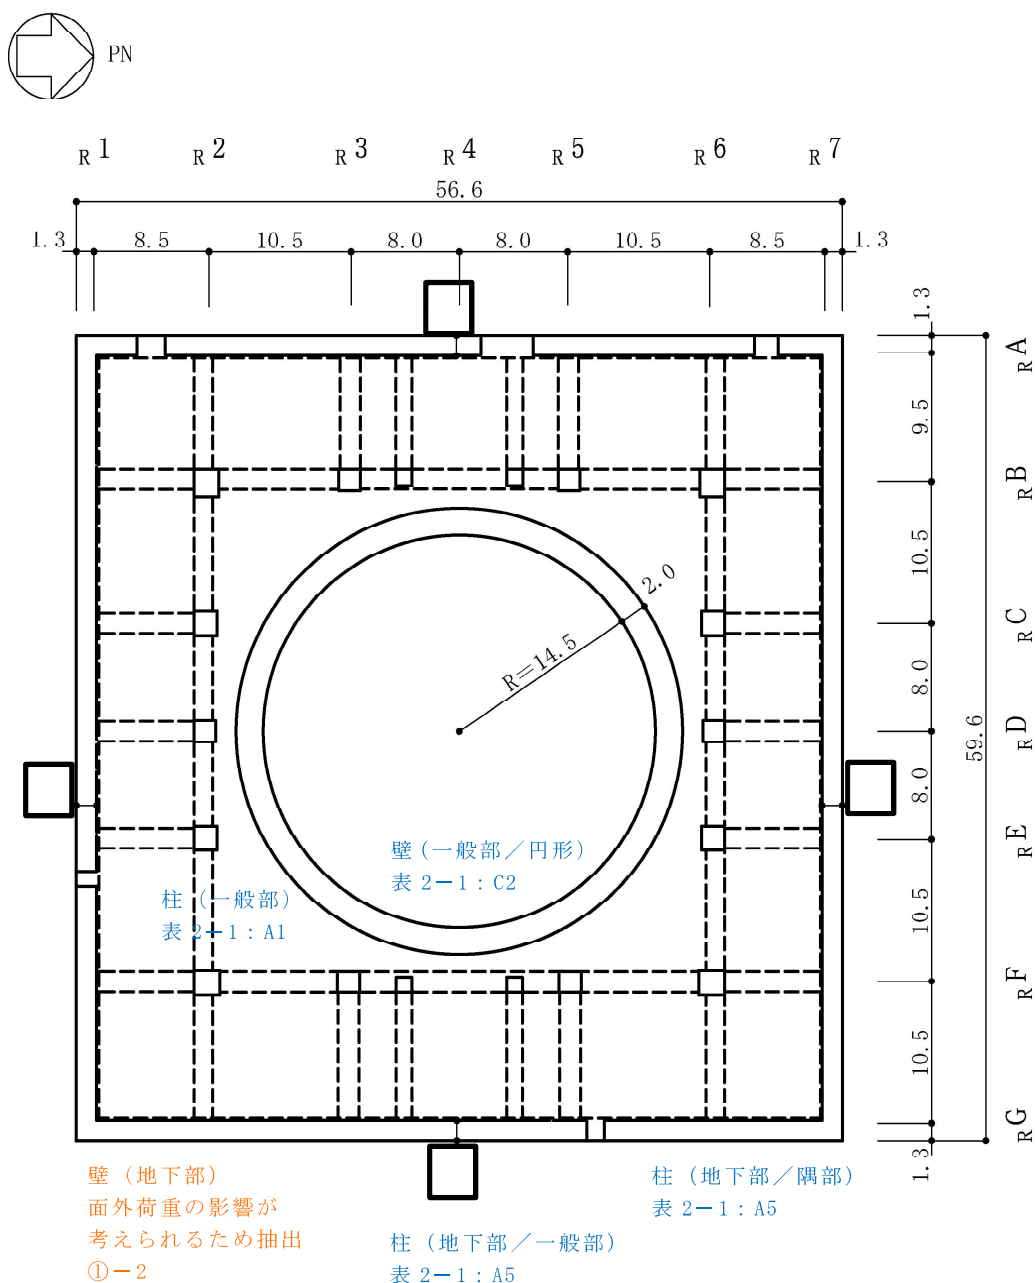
原子炉建屋の概略平面図（B1F，T.M.S.L. 4.8m）（3/8）（単位：m）
